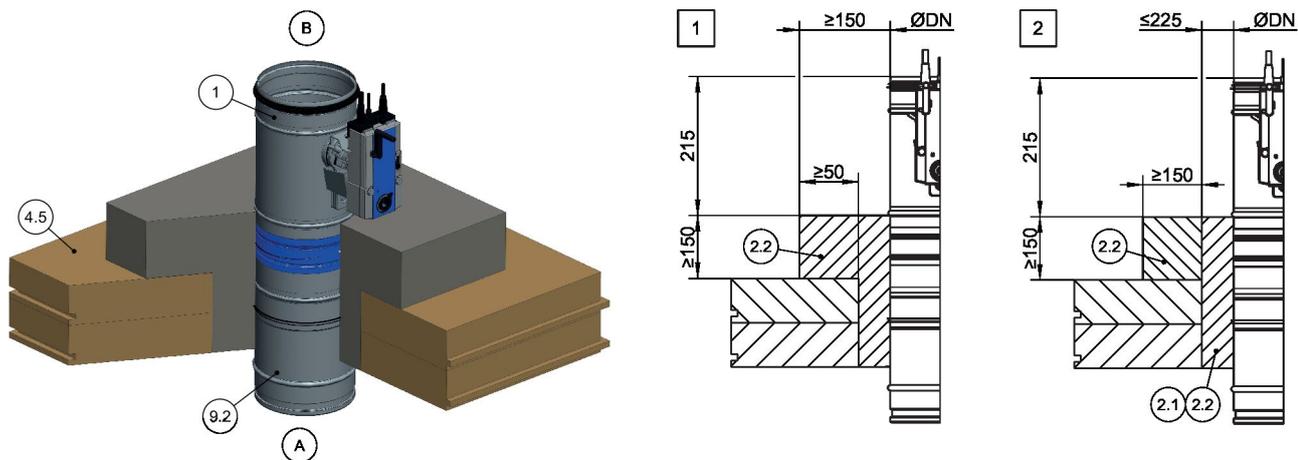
Nasseinbau in Massivdecke in Kombination mit Holzbalken-/Leimbinderdecke
